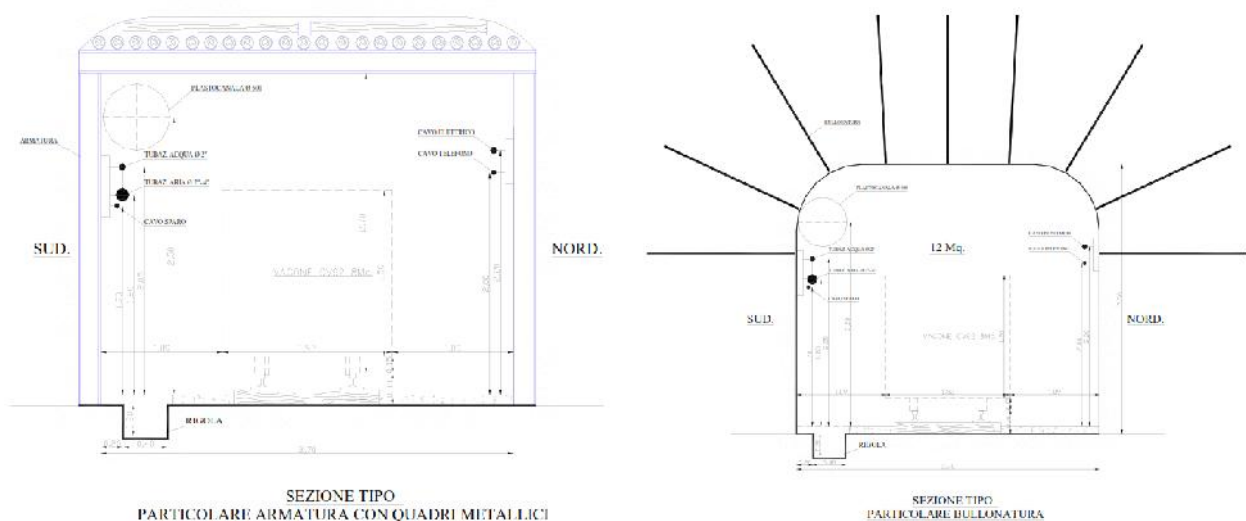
Sezioni tipo di consolidamento della sezione delle gallerie di carreggio
